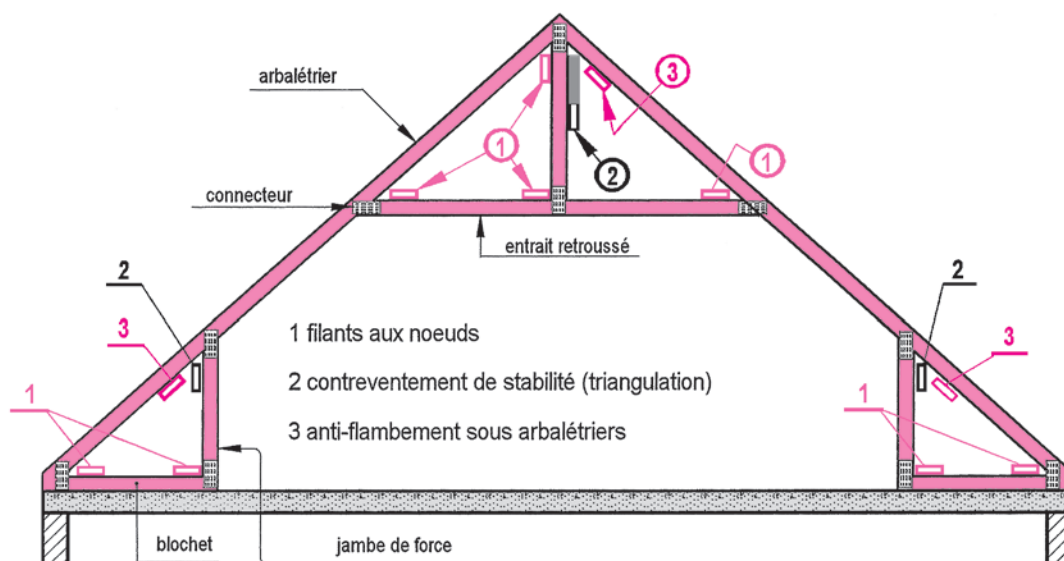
Élévation d'une ferme à entrait retroussé avec appuis sur le plancher en béton
